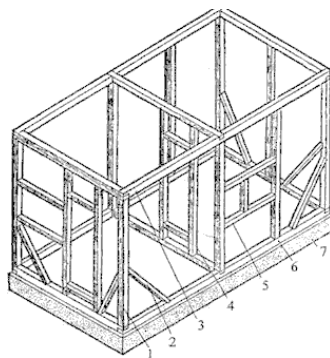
Каркас стен из бруса: 1 – стойка; 2 – раскос; 3 – балка верхней обвязки; 4 – дополнительная стойка для дверной коробки; 5 – продольный брус; 6 – балка нижней обвязки; 7 – фундамент.
